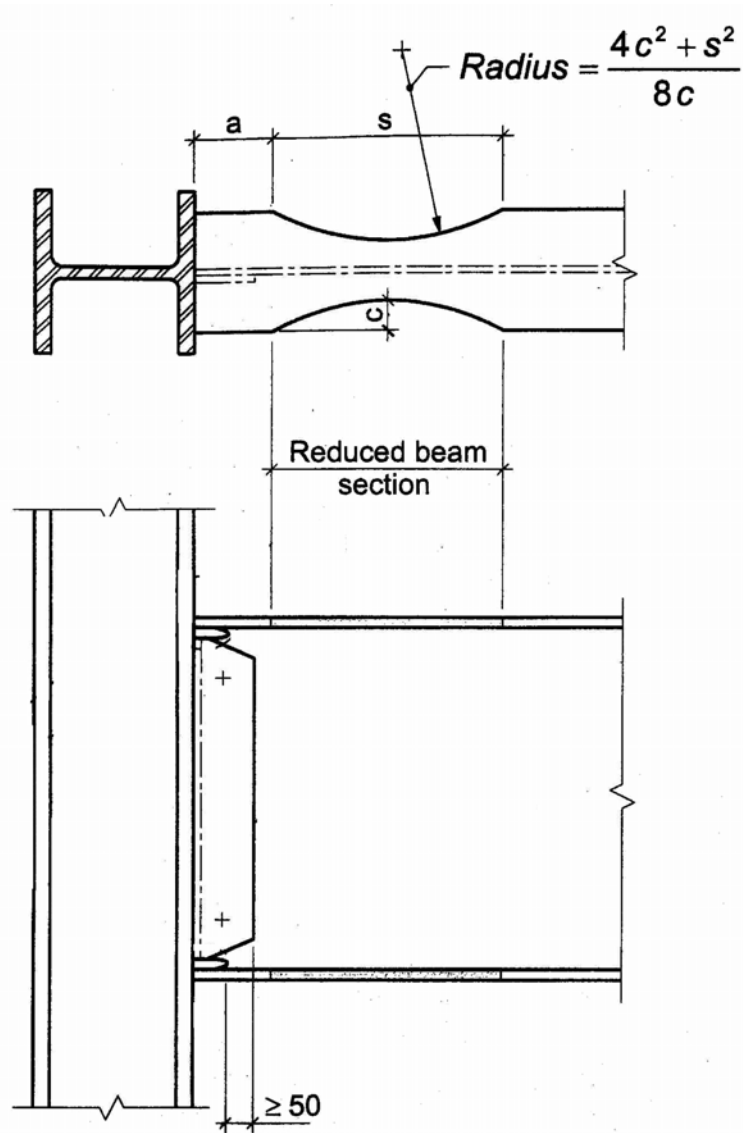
e. Poutre avec réduction de section « dogbone » (os de chien, vu sa forme) ou « RBS » (Reduced Beam Section). Ailes soudées, âme soudée à un gousset soudé à la semelle du poteau.
